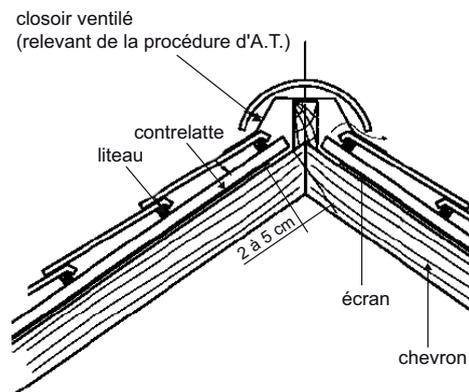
Montage avec closoir ventilé et planche de rehausse
